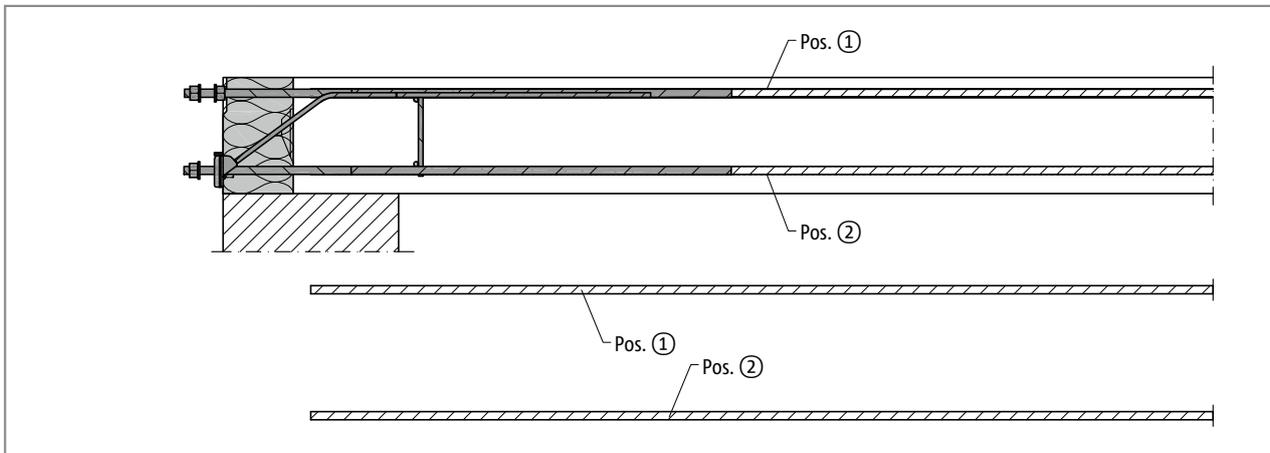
Schöck Isokorb® XT Typ SK-MM1-VV1: Bauseitige Bewehrung, Schnitt
